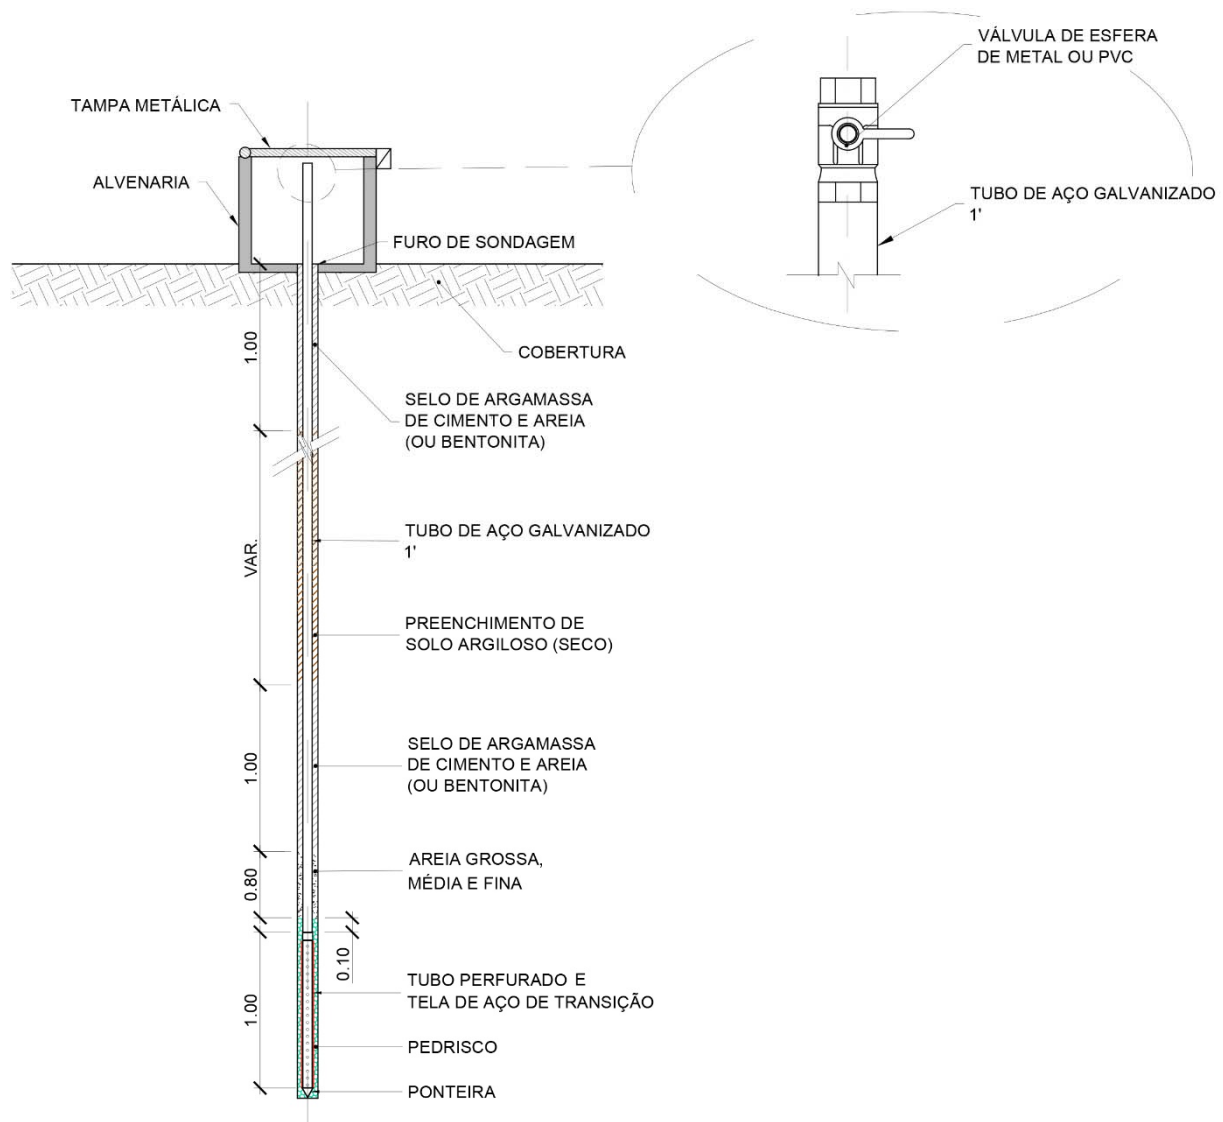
Perfil esquemático de Piezômetro tipo “stand pipe” ou Geotech.
